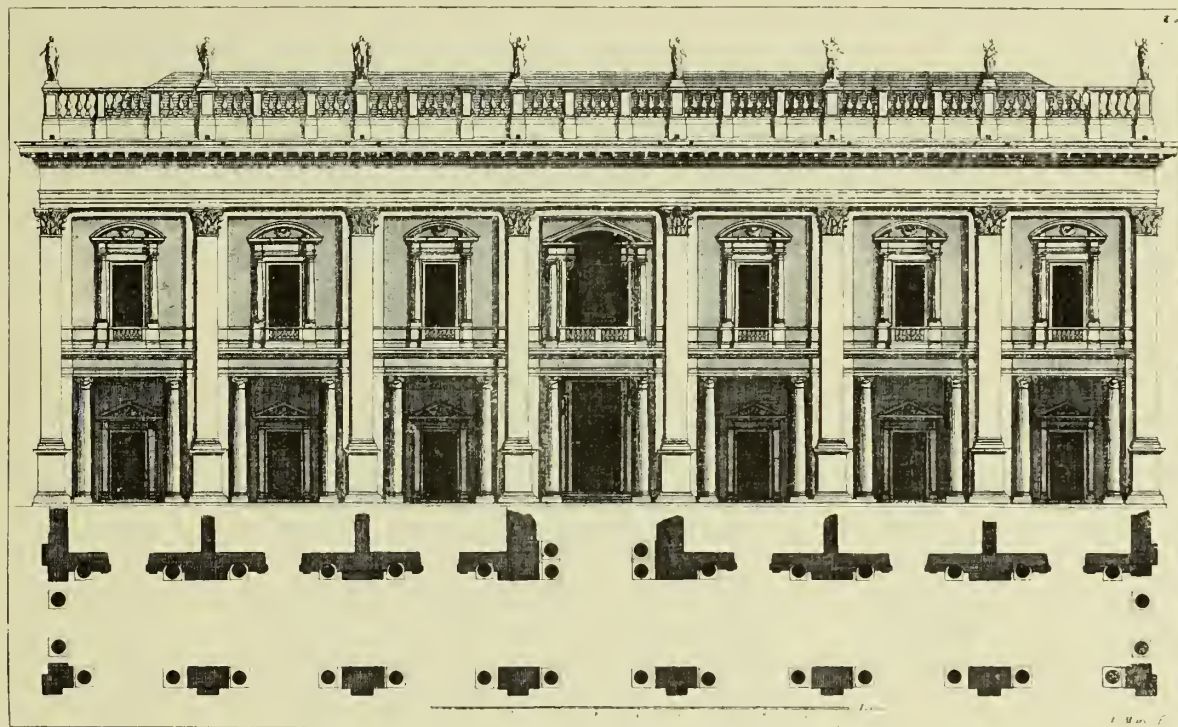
Palais des Conservateurs. — Plan et Façade. (Cabinet des Estampes.)
